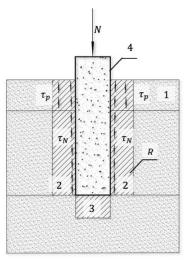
Напряженно — деформируемое состояние системы «Свайный фундамент — вечномерзлый грунт»: 1 — слой сезонно талого грунта; 2 — зона вмерзания сваи в грунт; 3 — зона компрессионного сжатия грунта; 4 — свая; N — нагрузка, передаваемая от сооружения и веса сваи; τ_p — выталкивающая сила от пучения промерзающих грунтов; τ_N — сопротивление сдвигу по боковой поверхности смерзания; R — зона влияния сваи на грунты.
